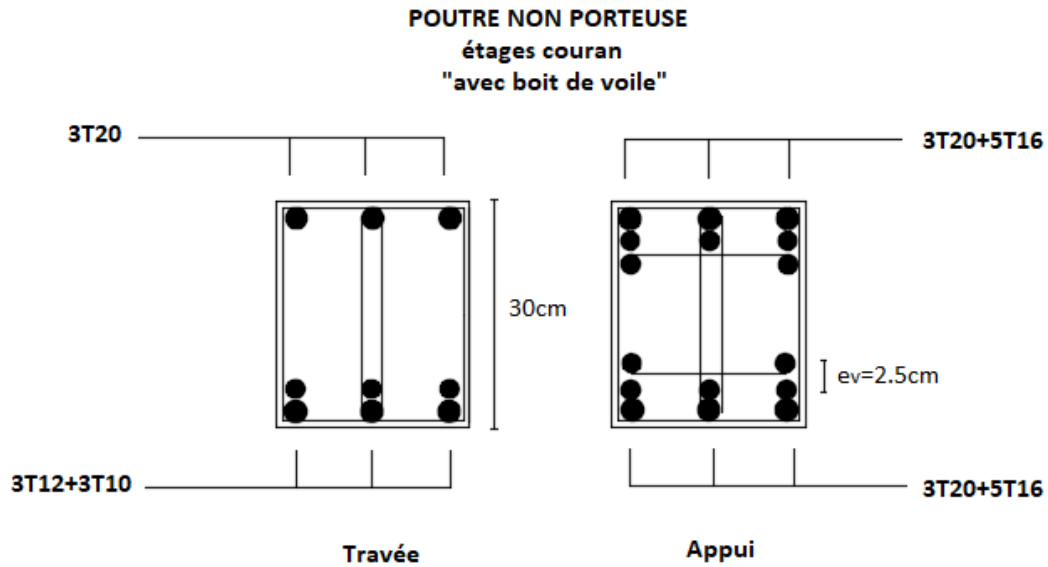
ferrailage des poutres non porteuse Etage Courant avec bout de voile.
